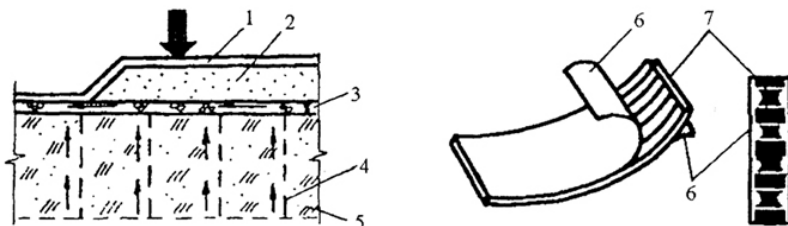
Уплотнение грунта внедрением бумажных лент и пригрузкой балластом:
